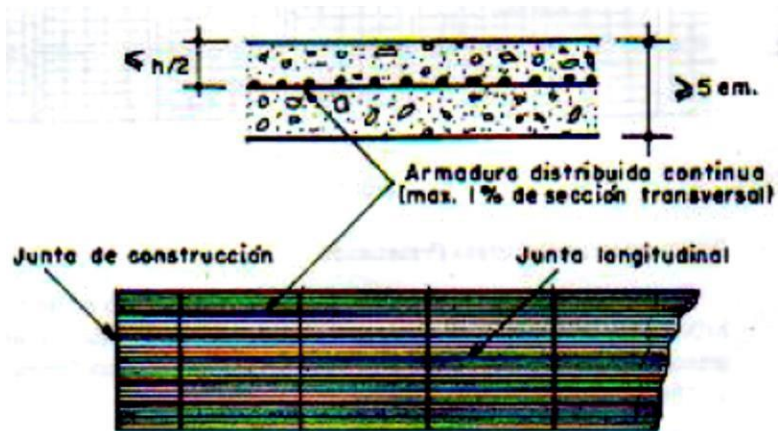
Pavimento rígido con refuerzo en las juntas
